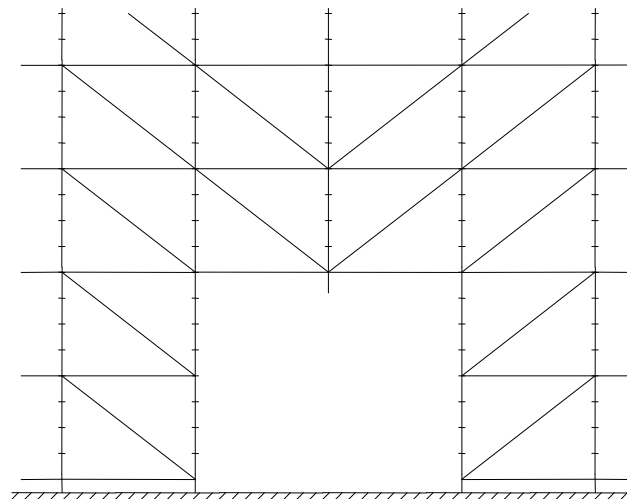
Vigas de celosía en U y estructura estática horizontal
